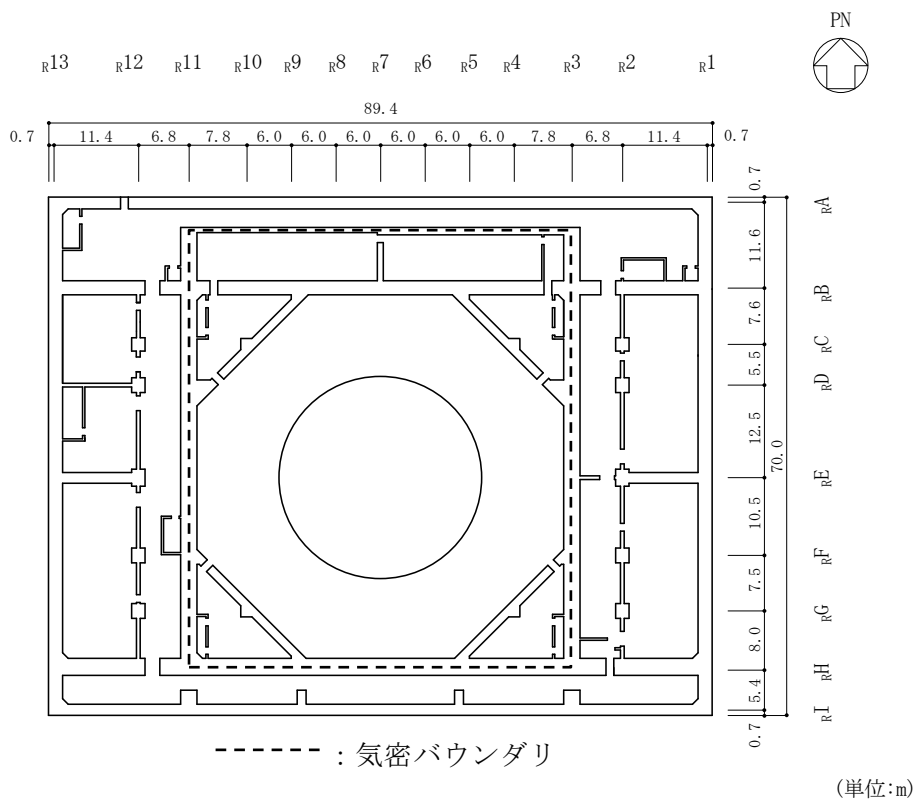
(1) 原子炉建物原子炉棟（二次格納施設）の概略平面図（EL 1.3m）
